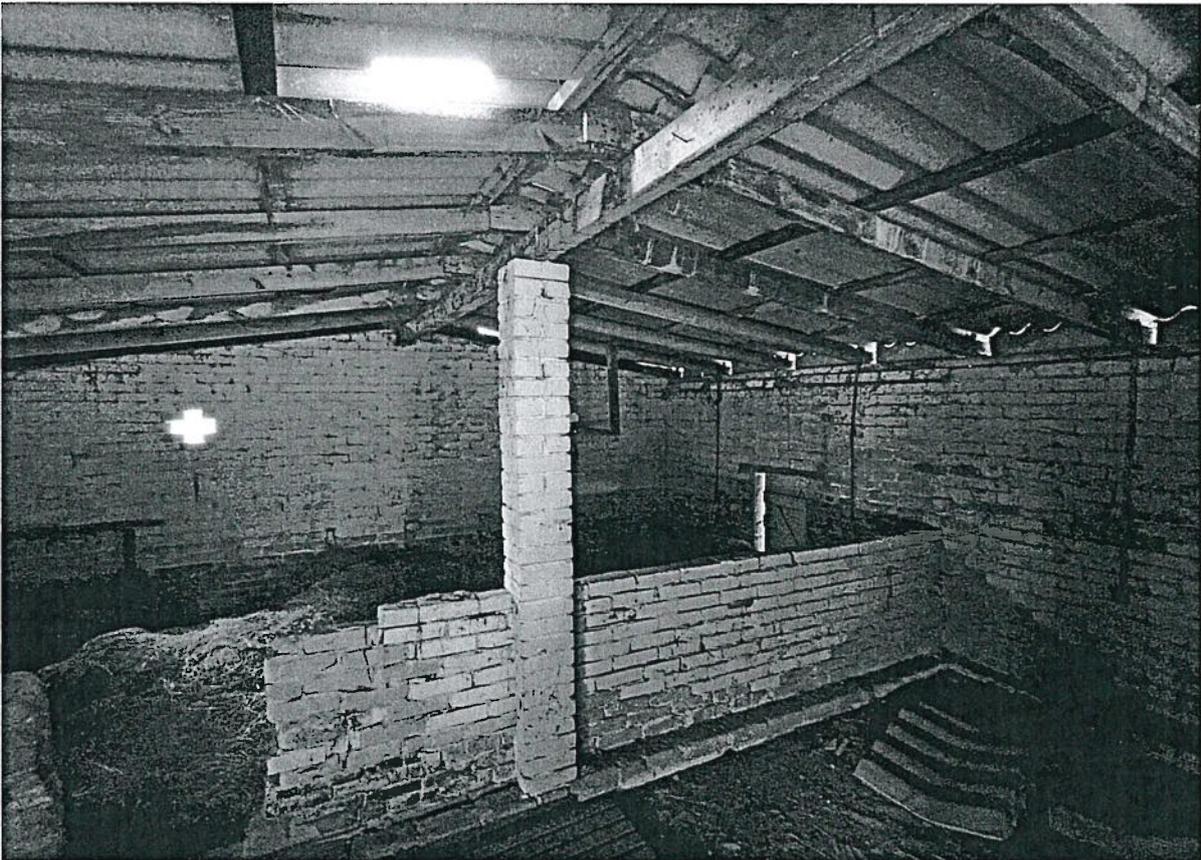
Blick in den Dachstuhl des Nebengebäudes.
